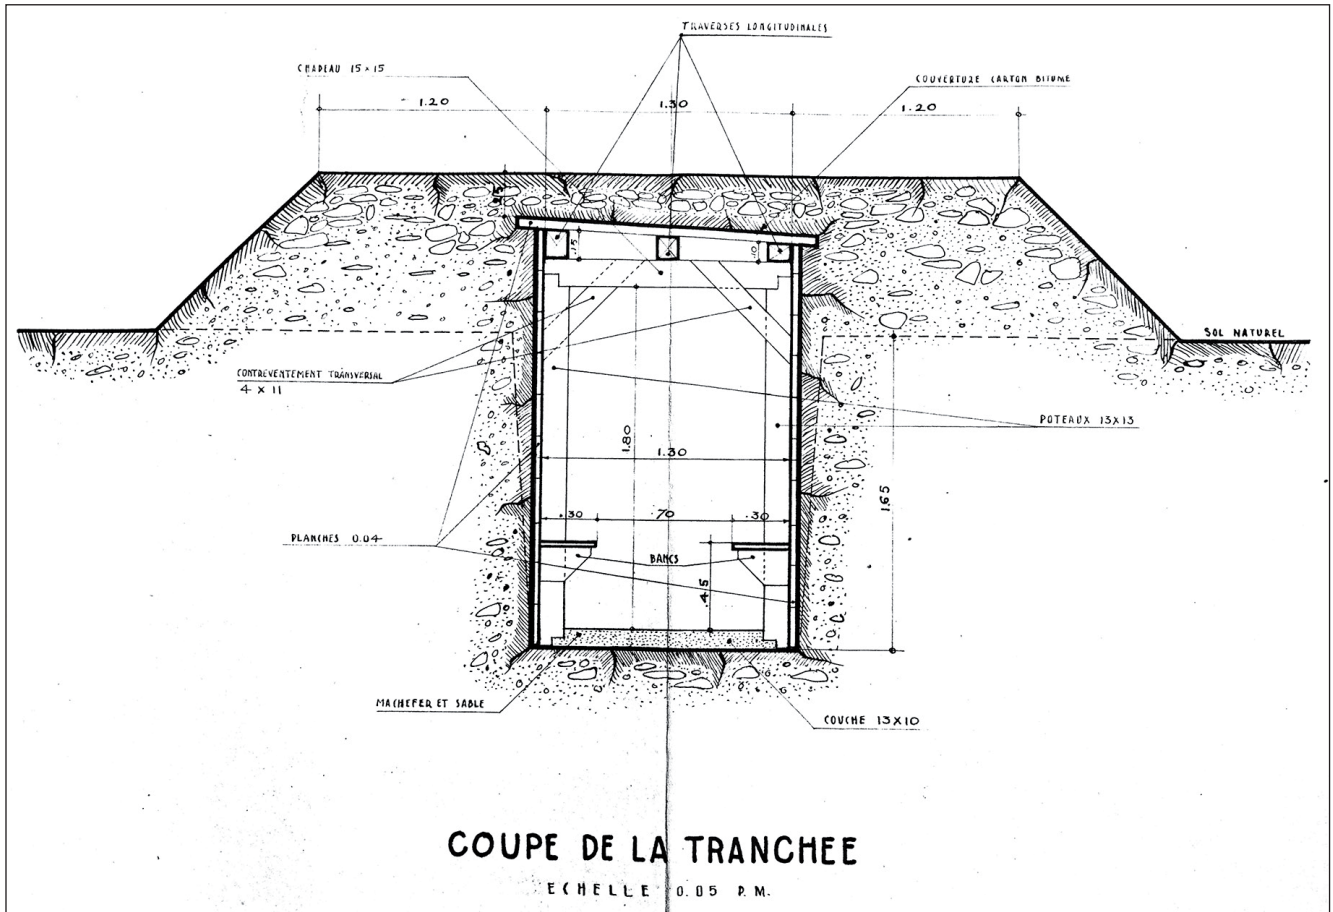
Coupe transversale d'une tranchée-abri à Gagny, 1942, Arch. mun. Gagny, boîte 1.
